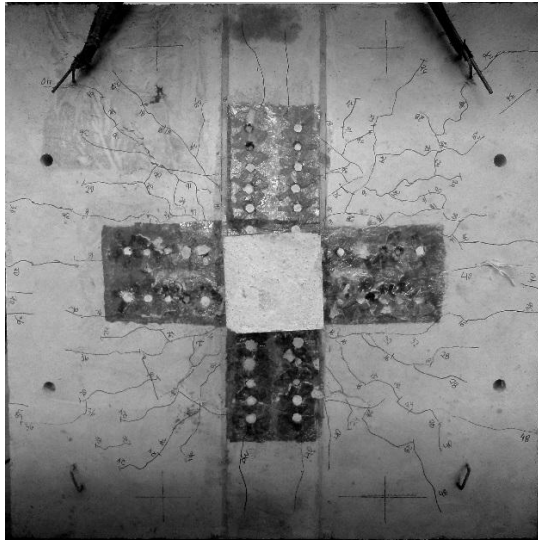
Padrão de Fissuração - LC-D
